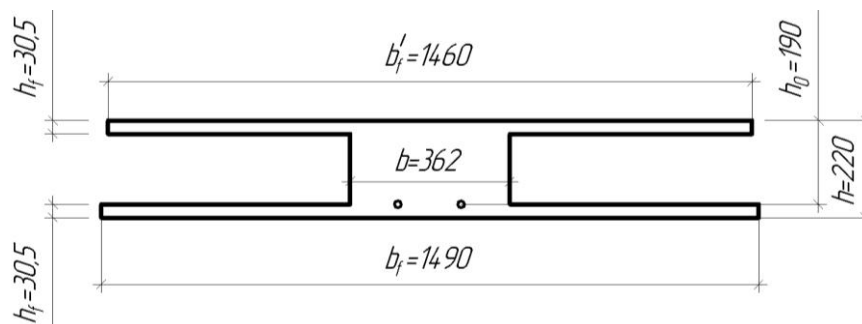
Расчетное сечение проектируемой плиты состоящей из пустот и перекрывающих этажи
